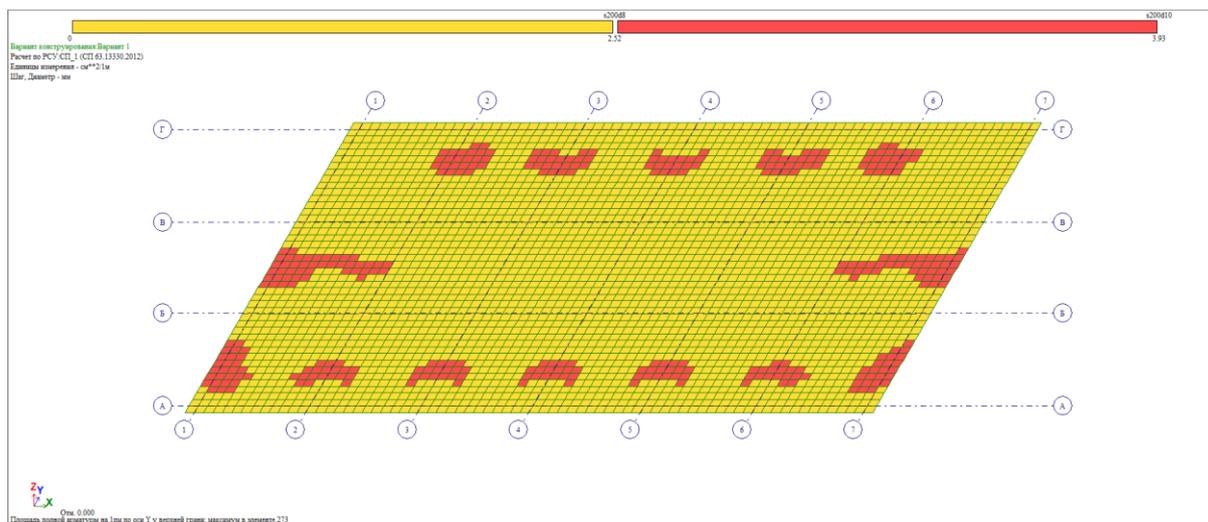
Площадь арматуры по оси У у верхней грани
